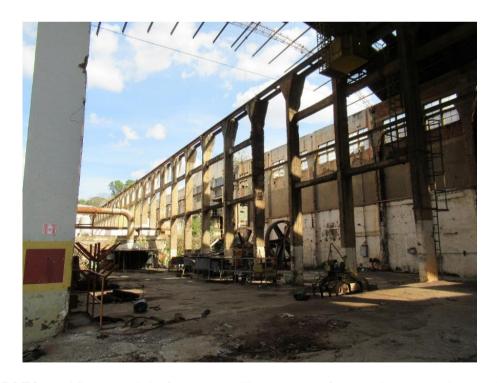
Vista geral de área sem utilização (contígua ao barracão de cana)
